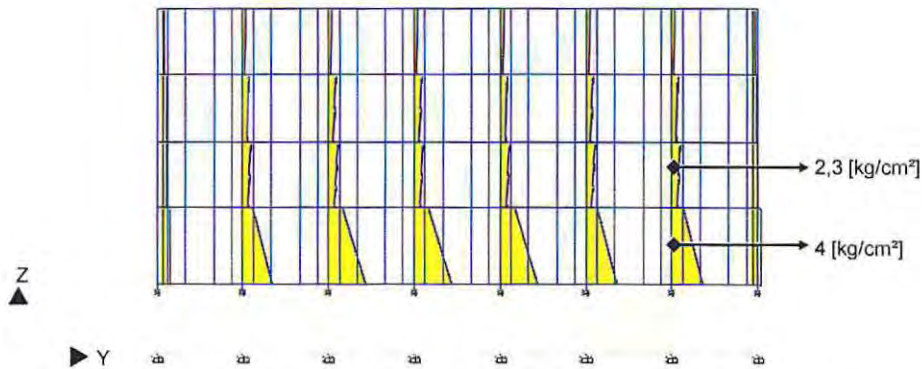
Esfuerzos de corte en albañilería de fachada, eje A, estructura aislada.
